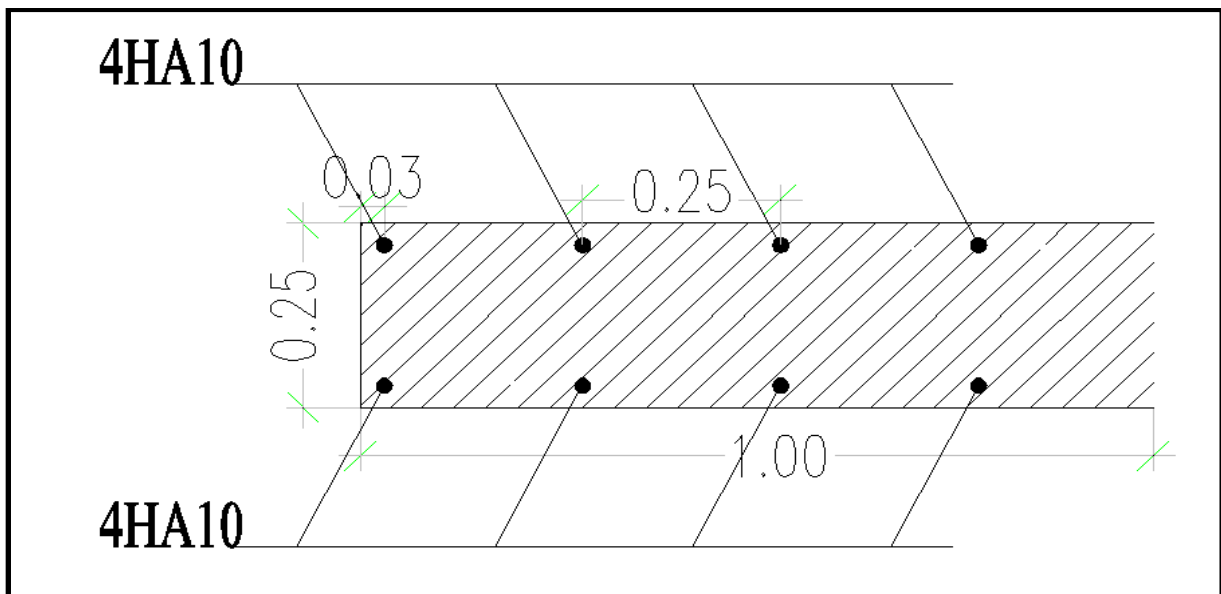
Schéma de ferrailage longitudinale de la dalle
